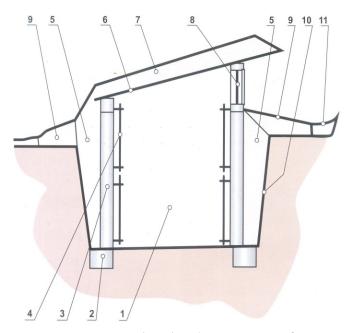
Схема траншейной теплицы (слева): рабочее помещение; 2 —ленточный фундамент; 3- металлические стойки; 4- стеновое покрытие; 5 — засыпка из теплоизоляционного материала; 6 — потолочное перекрытие; 7 — теплоизоляция кровли с гидроизоляцией; 8 — окно из многослойного стеклопакета; 9 — откосы стен;10 — гидроизоляция откосов; 11- водоотводящий желоб
